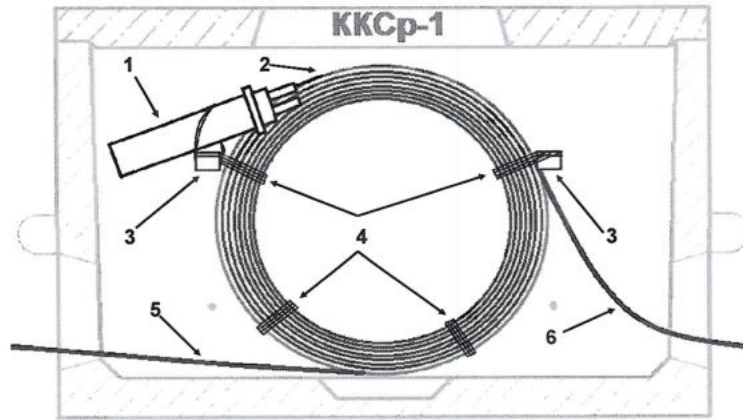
Крепление муфты и бухты запаса ОК на боковой стене колодца ККСр-1:
